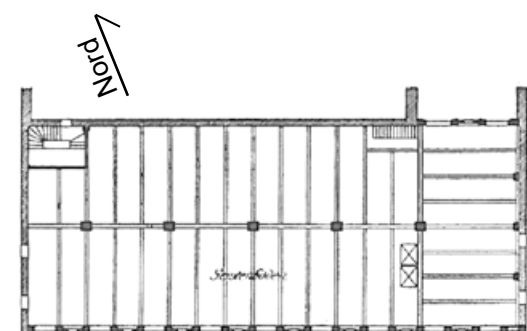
Grundriss 2. OG (SBZ 1912, S. 130).
